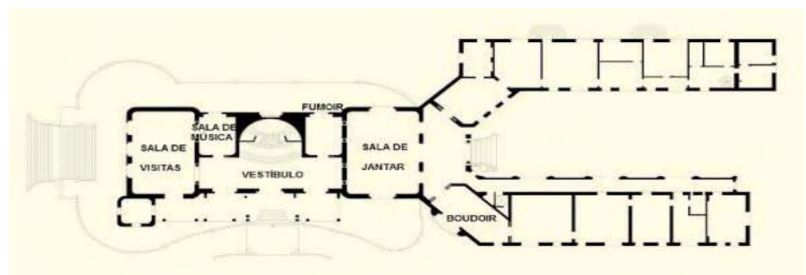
Ala social do primeiro e segundo pavimentos. Plantas de Lucas Cavalcanti, *Projeto A casa Senhorial Lisboa, Rio de Janeiro, Goa*.
